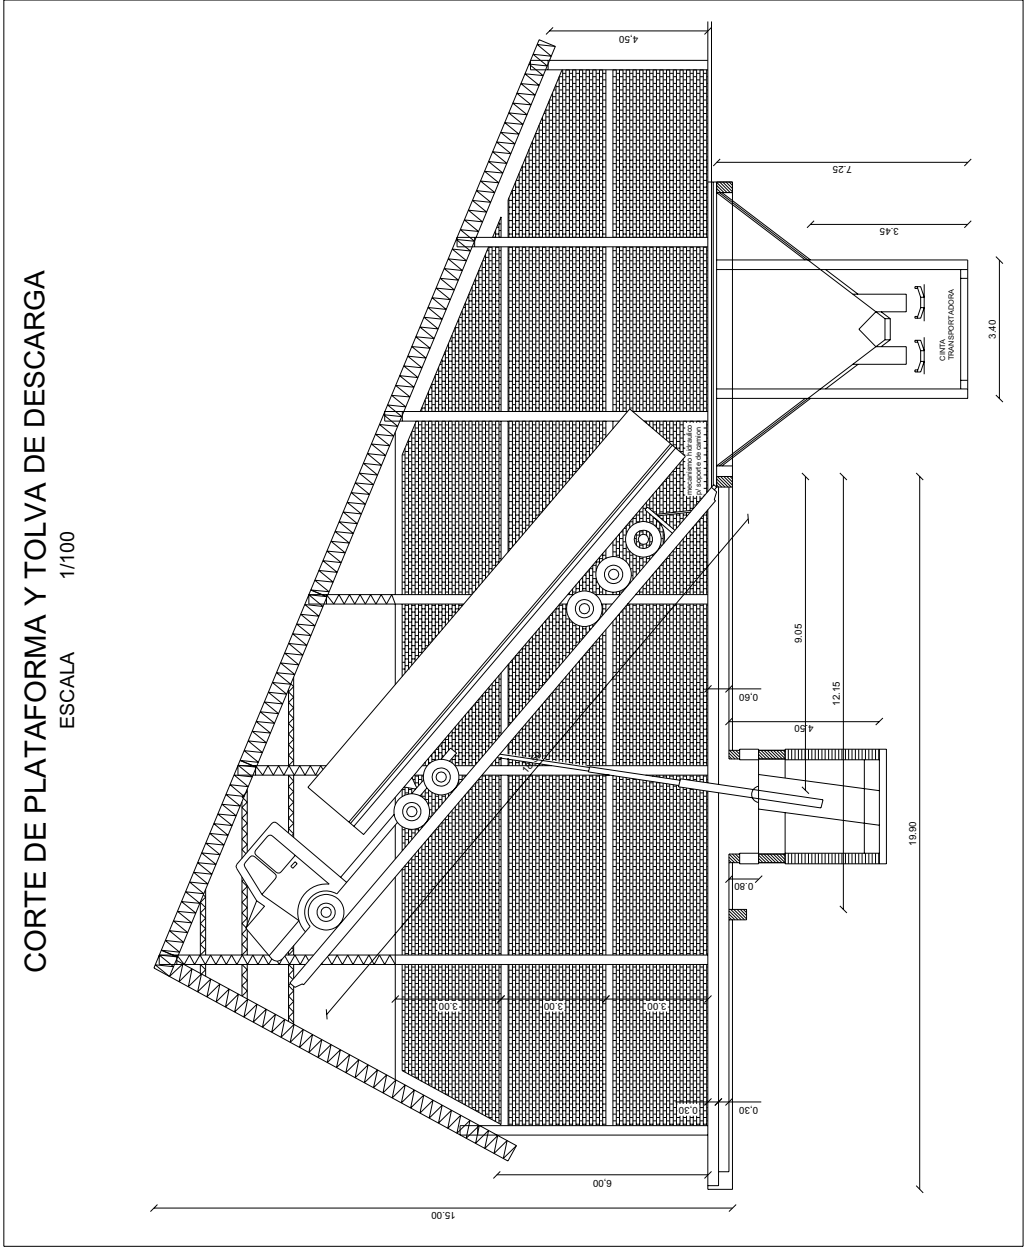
Plano de la Sección Transversales de la Plataforma
